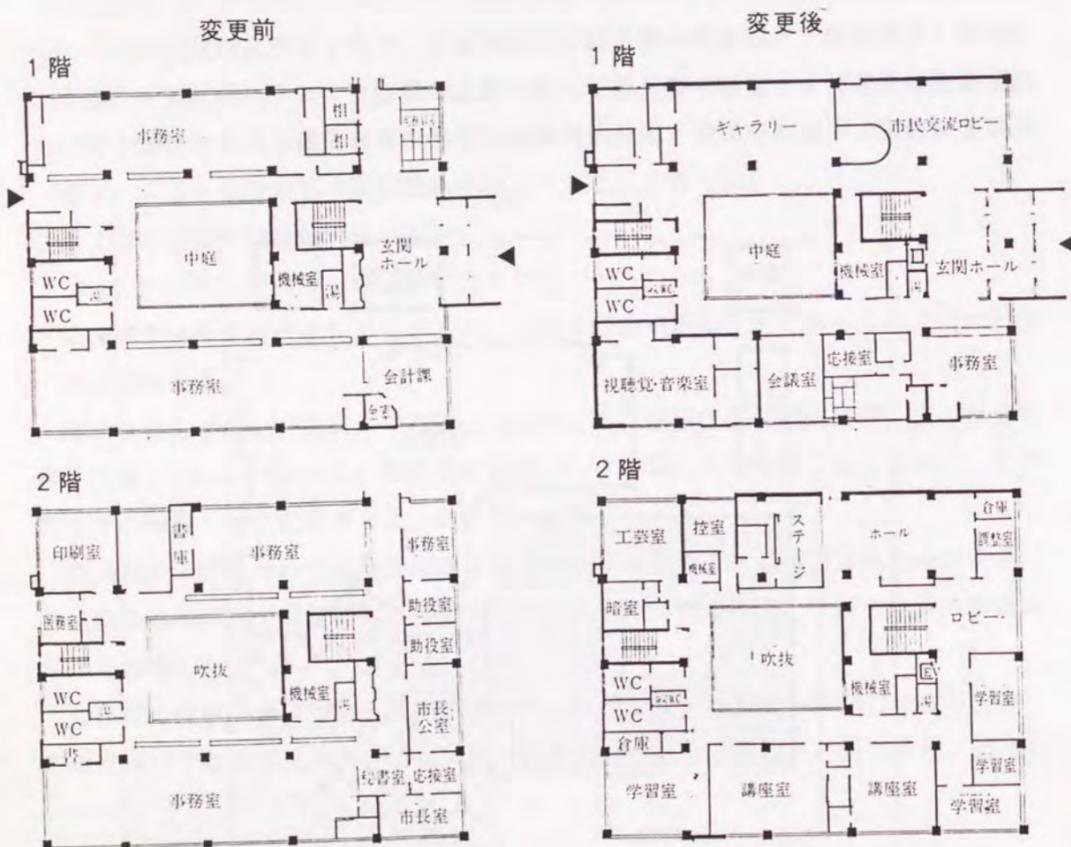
小平市中央公民館 (旧市庁舎) の1, 2階平面図
